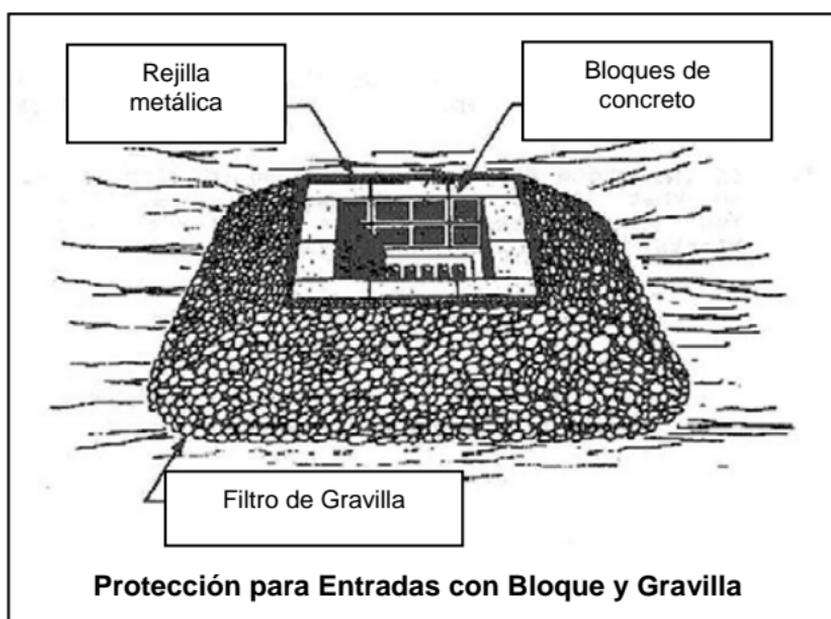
Detalles para la protección de entradas usando bloque y gravilla.
